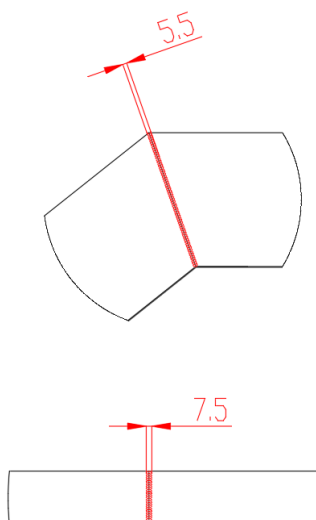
Unión vigas en diagonal- vigas horizontales escalera.
